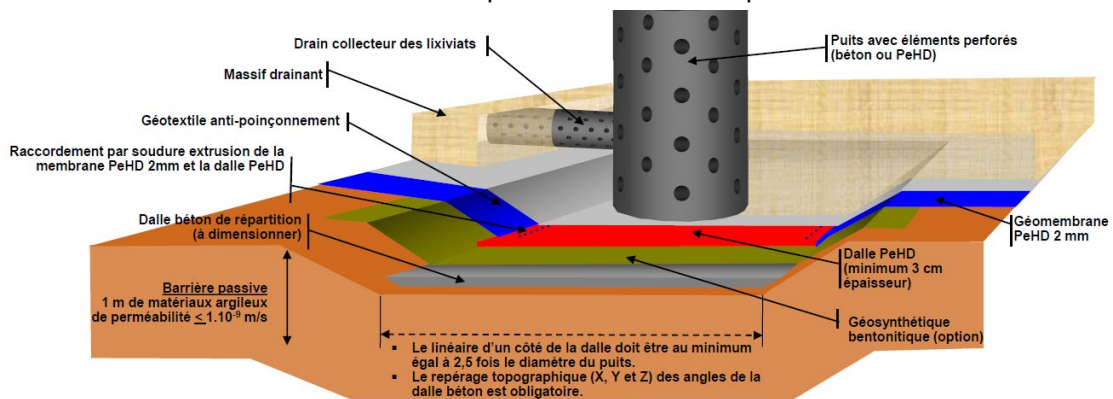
Schéma de principe de la mise en place des dalles béton en fond de casier
